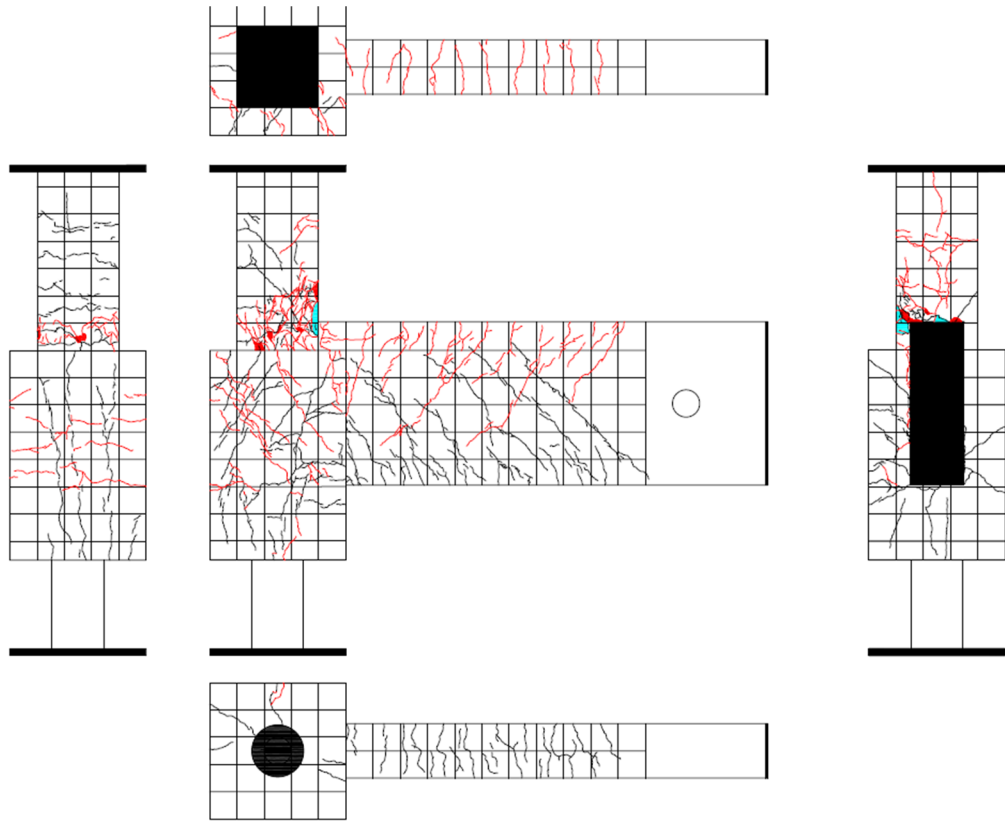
試験体 D-3 ひび割れ状況 (7Cycle)
